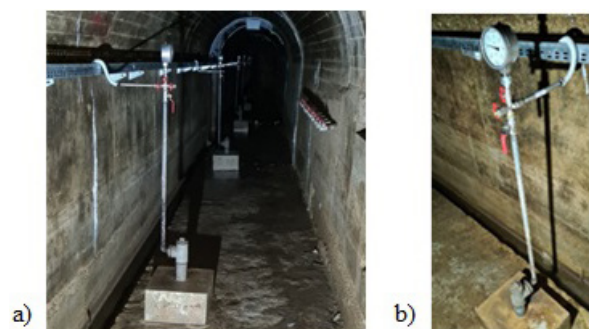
Prikaz instalacije VW piezometra i manometra u betonskoj brani
